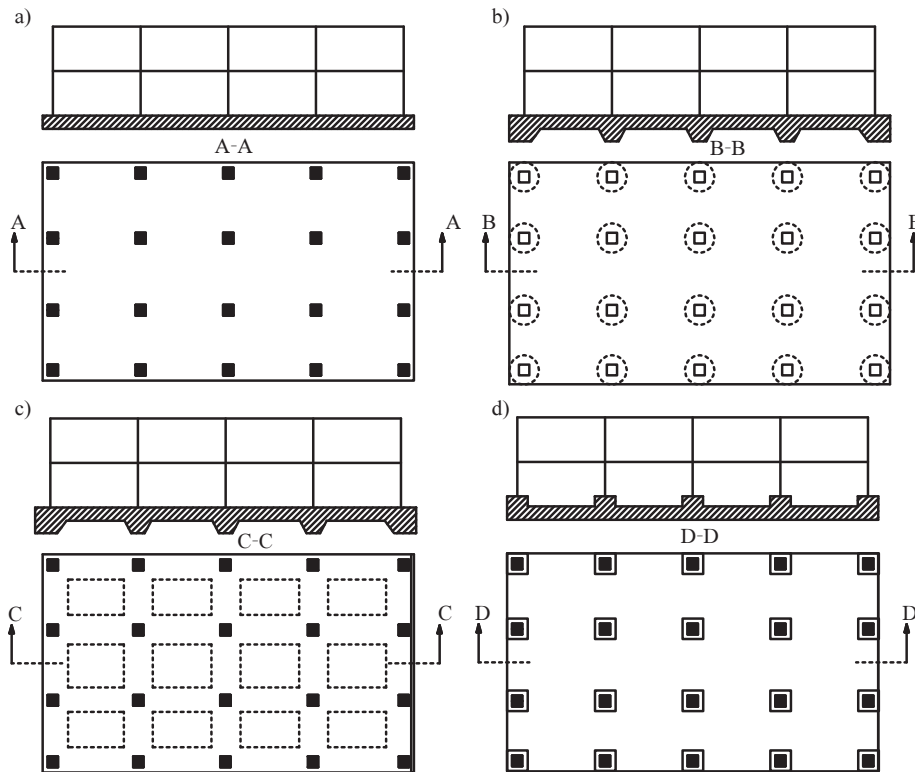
Cấu tạo chi tiết móng bằng BTCT
